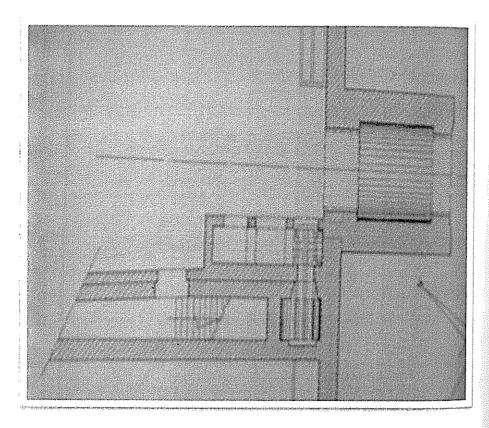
مسقط أفقي لباب الهري الرئيس، نقلاً عن de la qasba Moulay Ismail.
